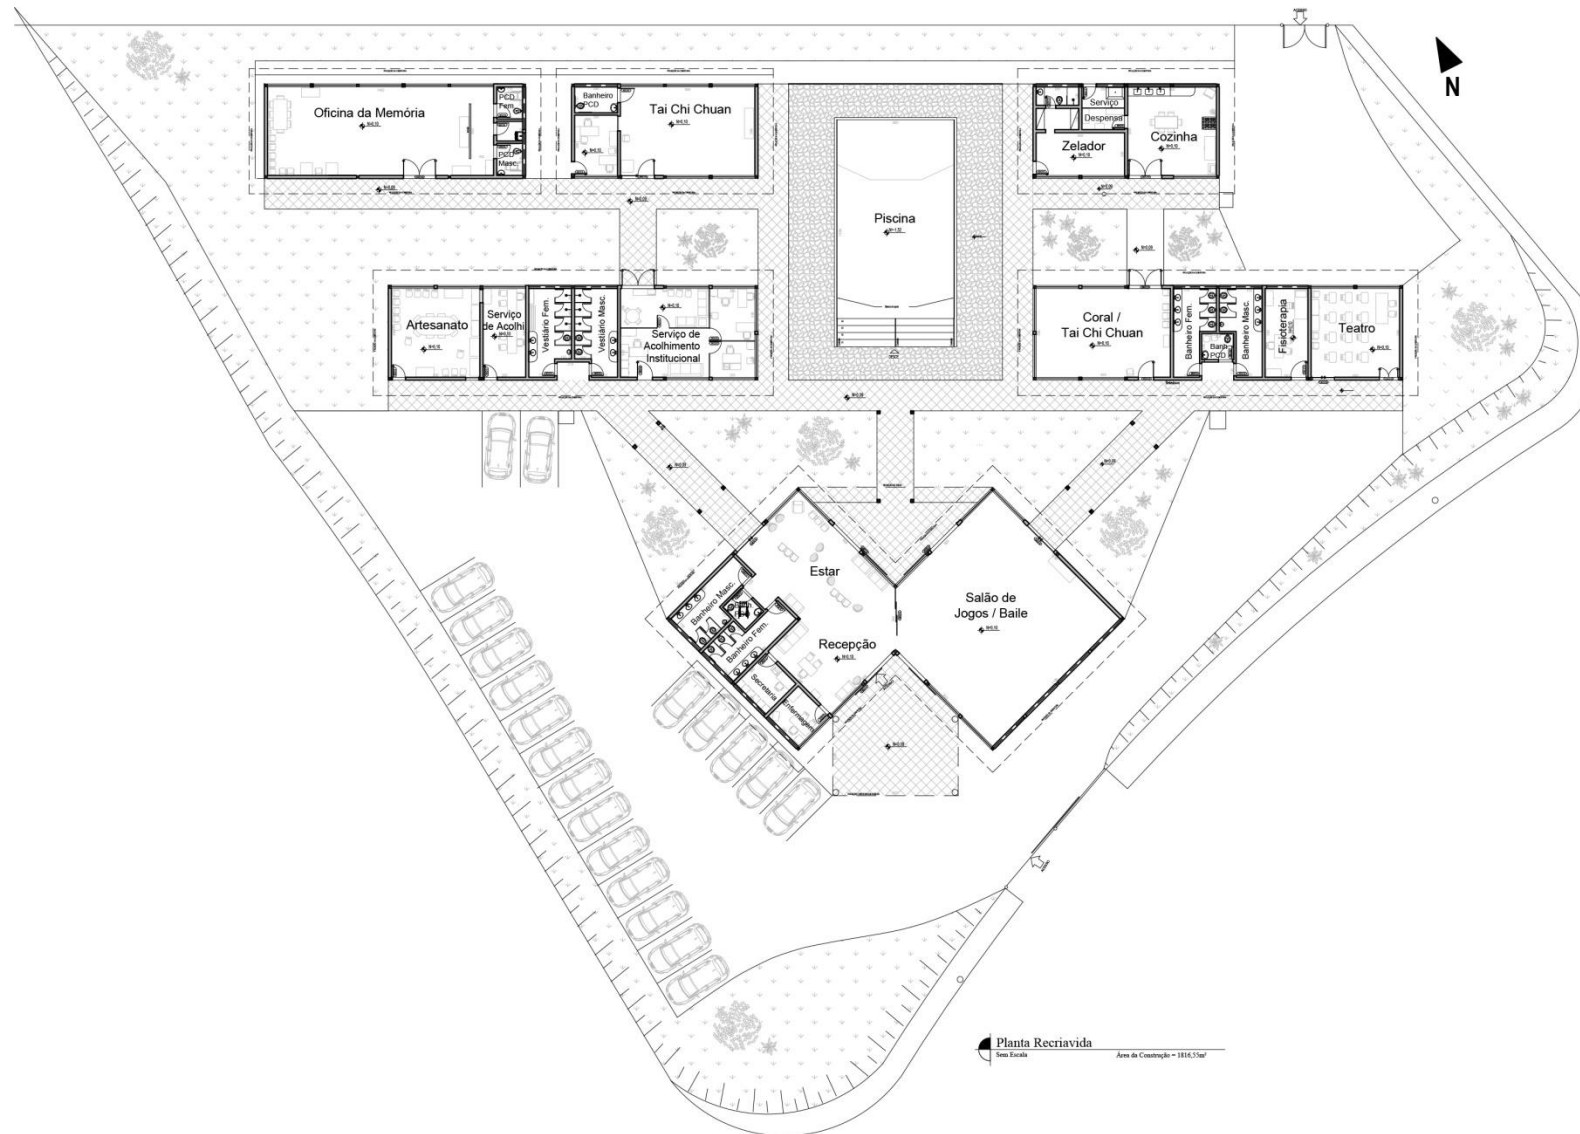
Planta Baixa com layout da sede do Programa Recriavida
